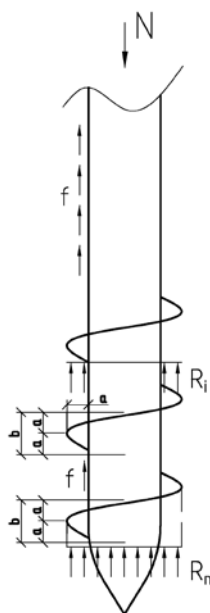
Предлагаемая расчетная схема для доработки методик расчета применительно к узколопастным винтовым сваям.
